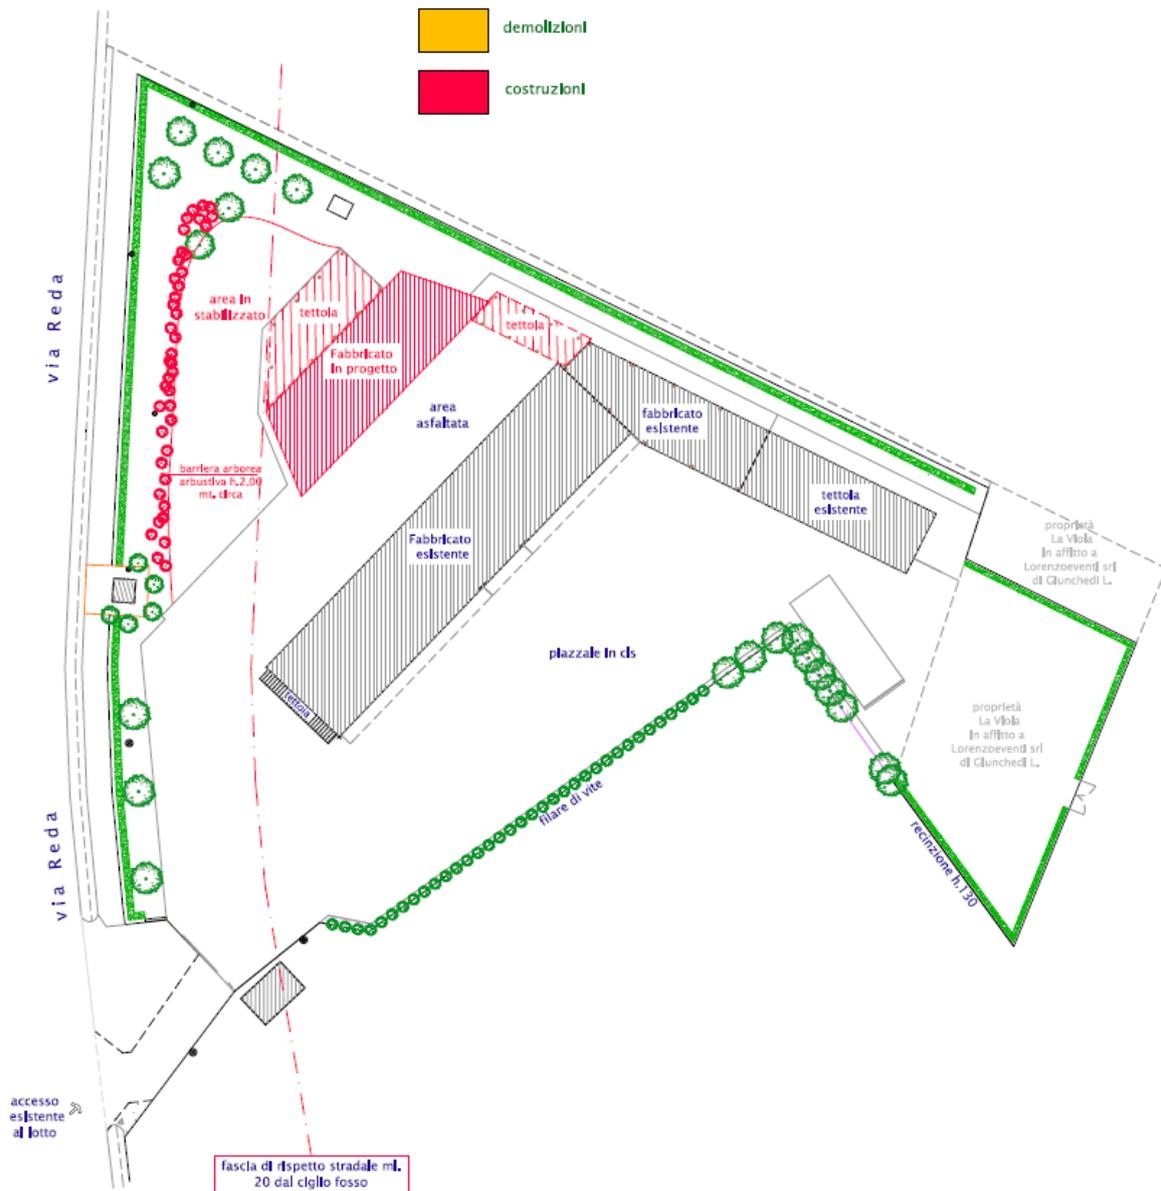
Estratto Tavola 3 - Stato comparato in planimetria generale
